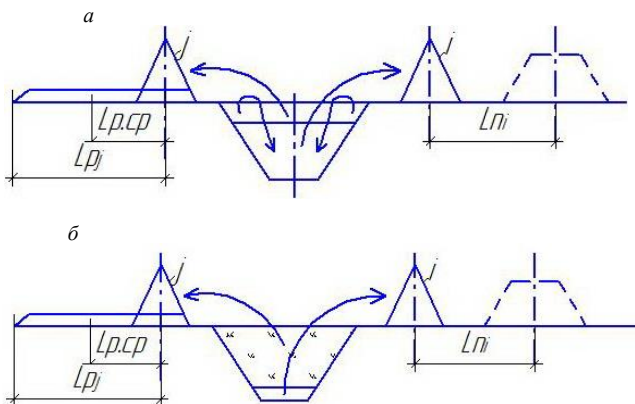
Схемы укладки грунта в отвалы и использование его в насыпи: *а* – на минеральных грунтах; *б* – на торфяных грунтах
